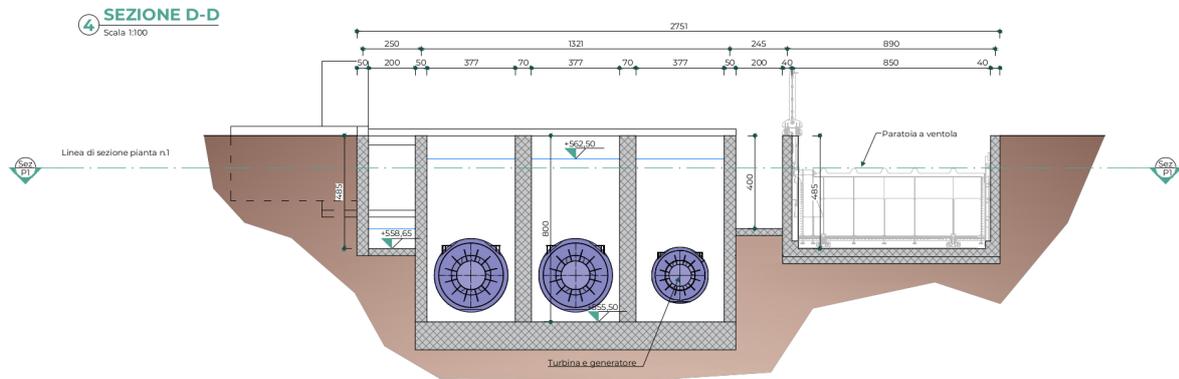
Sezione trasversale dell'impianto in progetto.
